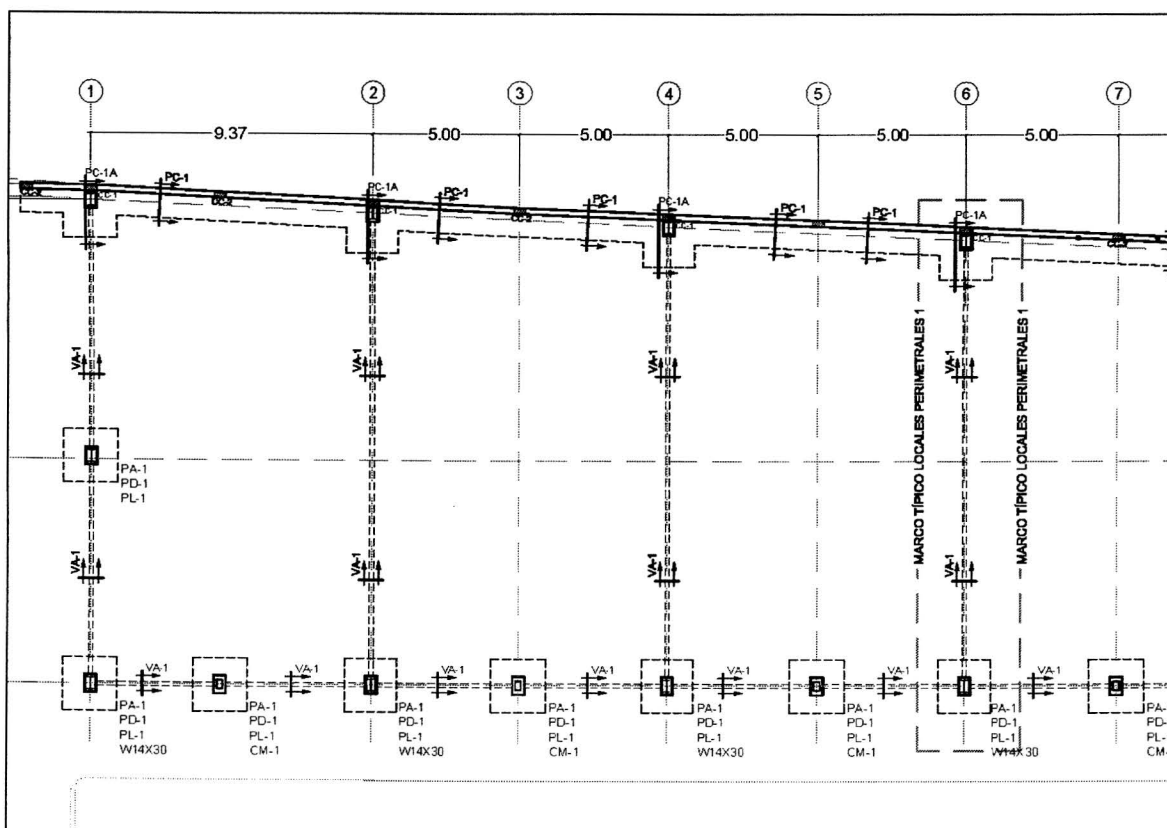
Sección de planta de fundaciones propuesta por diseñador
